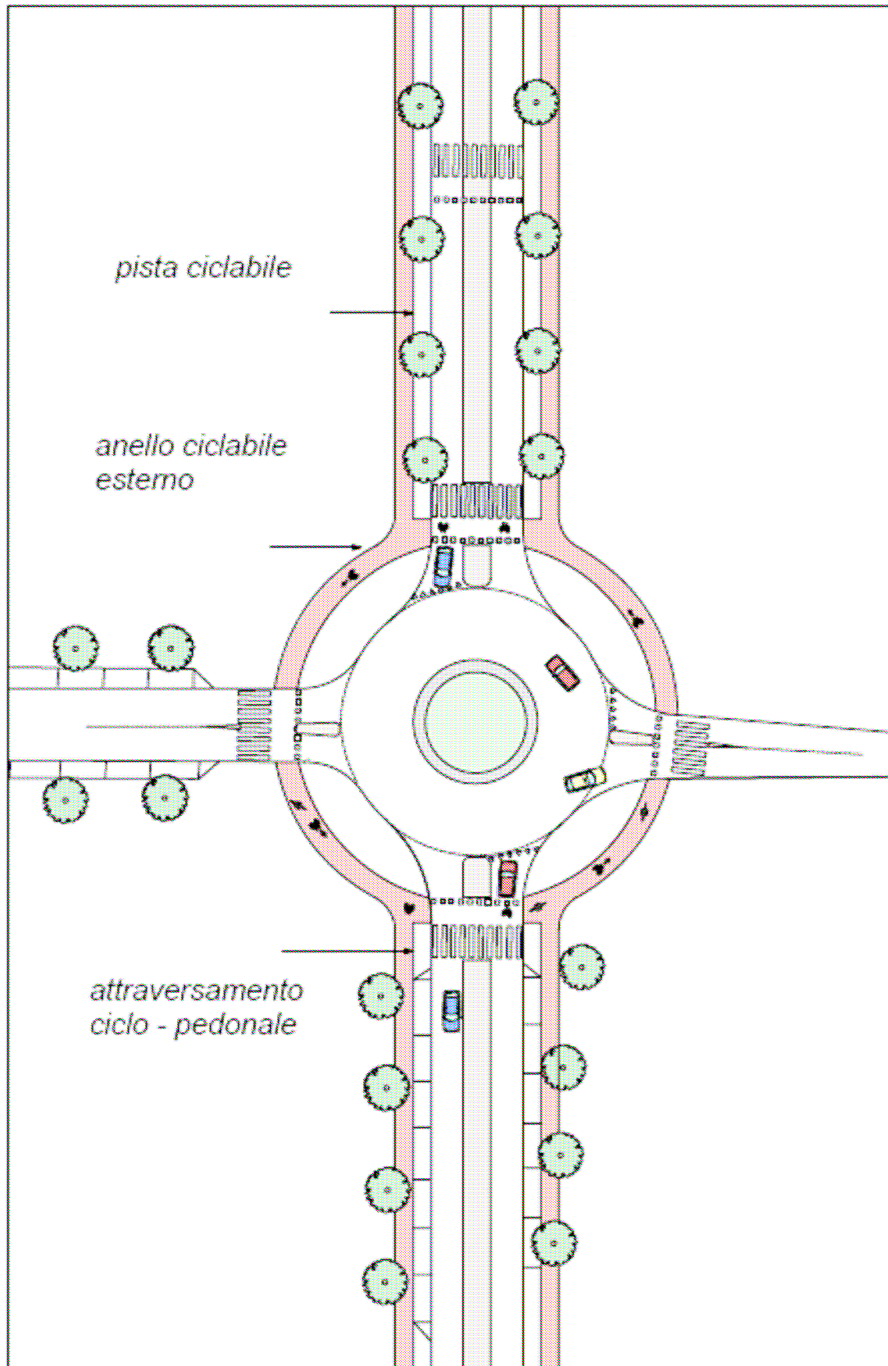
Organizzazione planimetrica di una rotonda urbana
